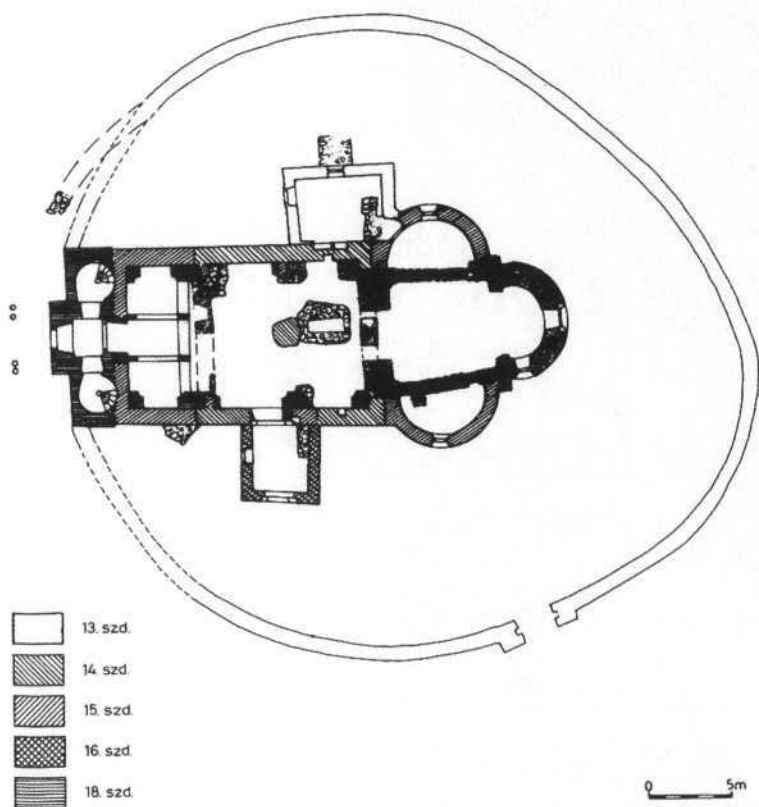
Tar, Pfarrkirche, Grundriß mit Bauperioden.
